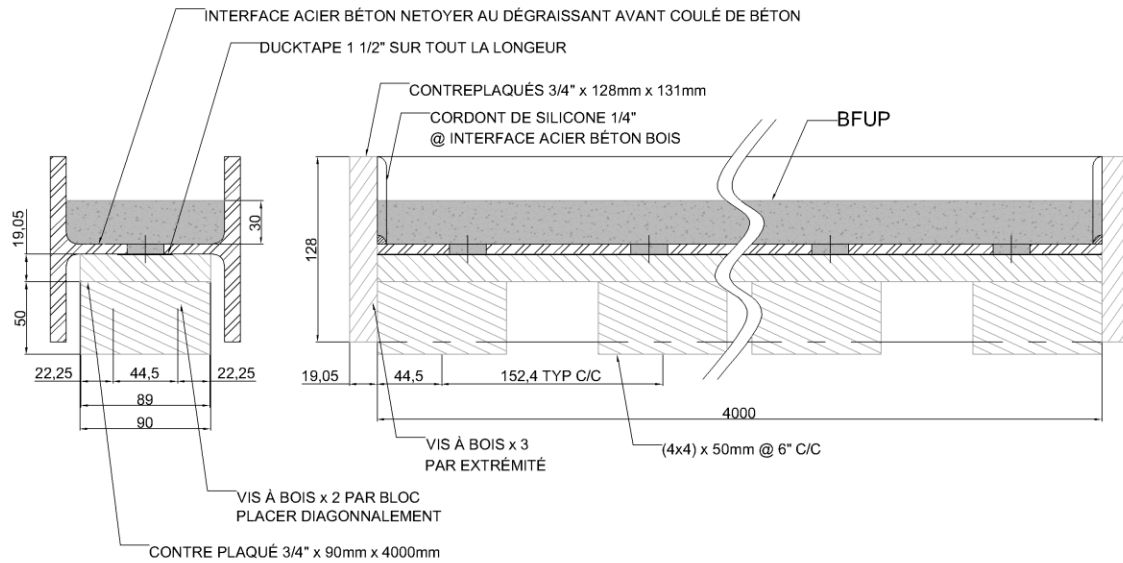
Plan du coffrage de la poutre d'acier pour essais préliminaires
